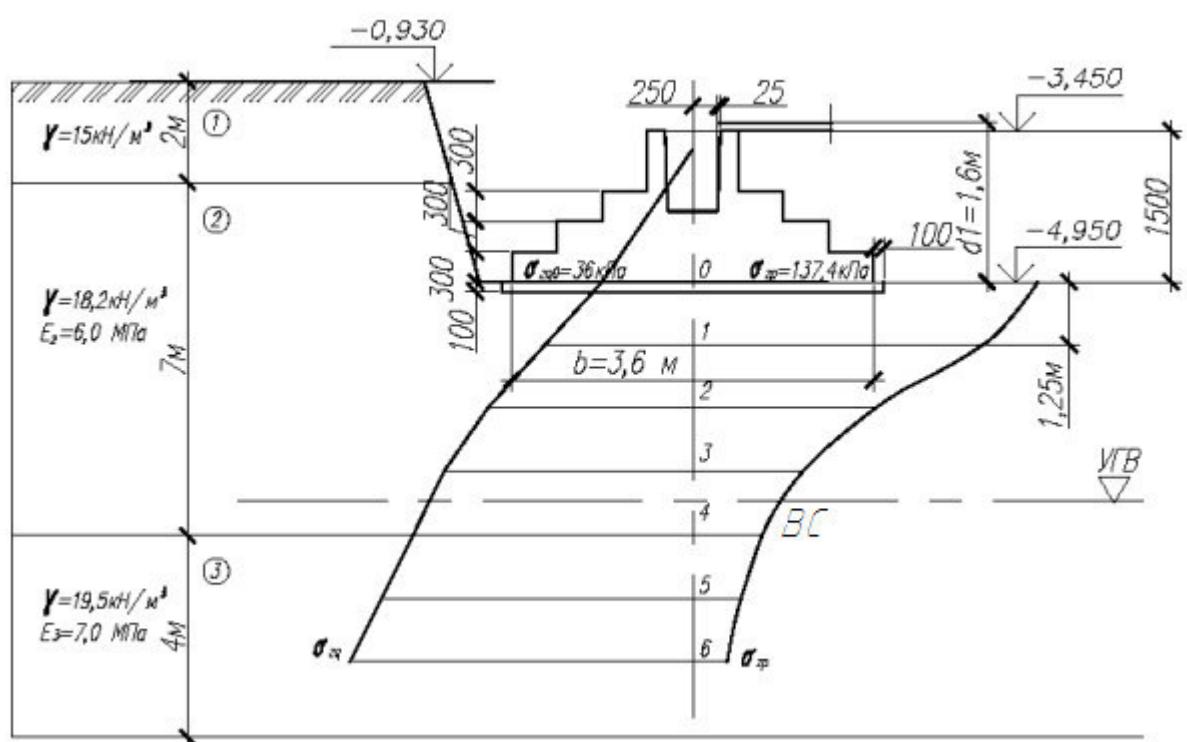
Схема расчета осадки фундамента на естественном основании.
